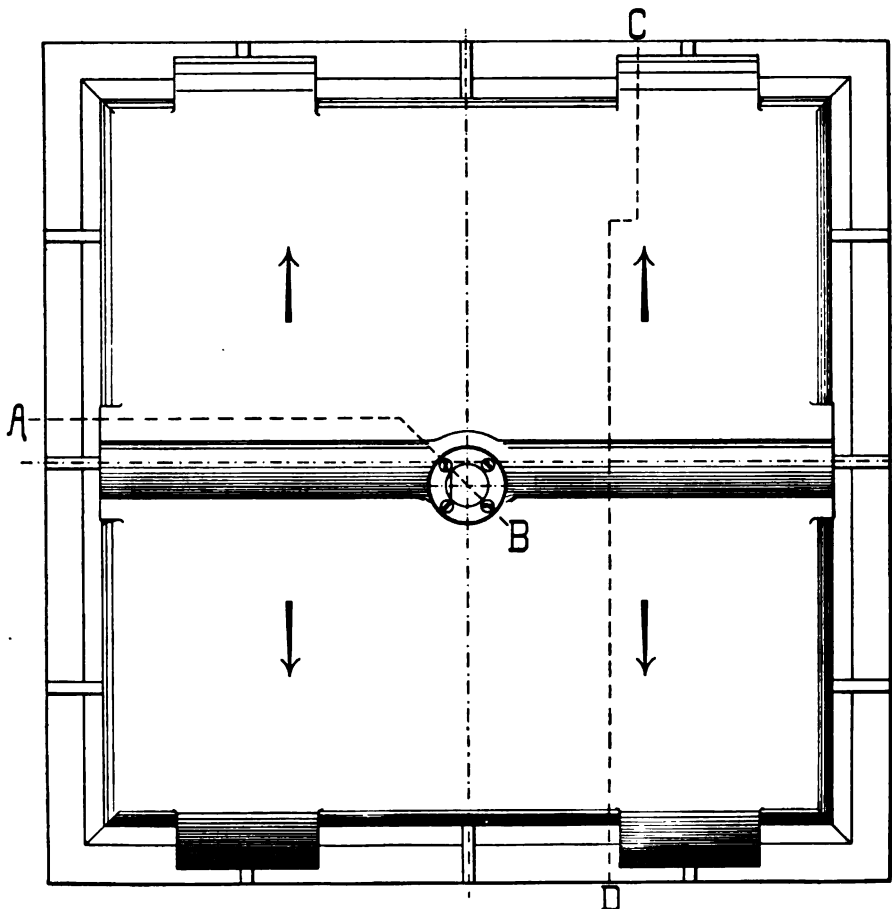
Grundriß zum Wasseralfinger Einsteigschachtkasten. M = 1 : 12.
